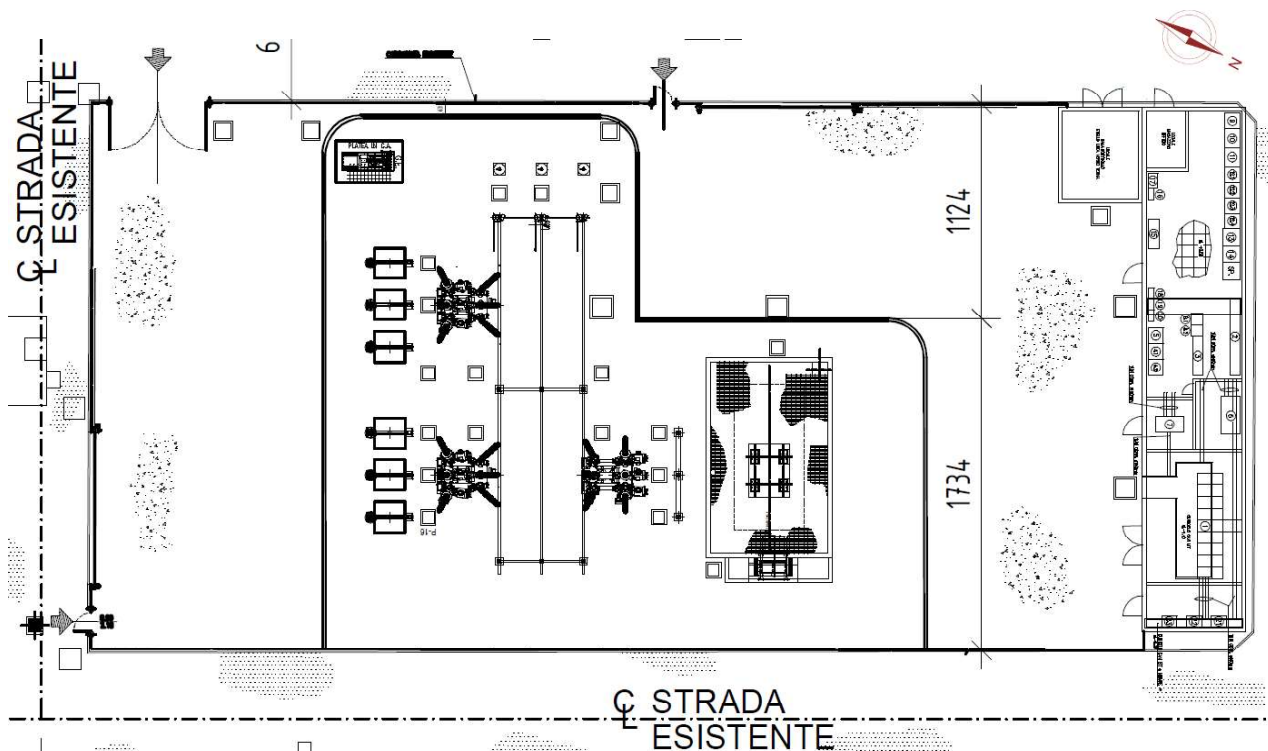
Layout dell'impianto BESS: dettaglio dell'area sottostazione MT/AT
